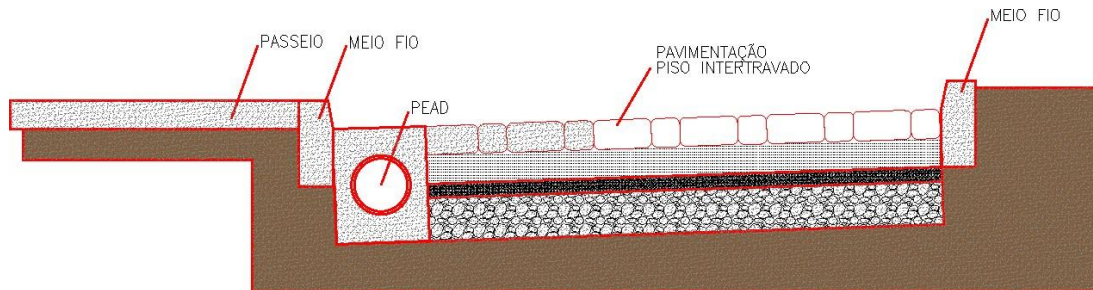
Perfil transversal com caixas de ralo de um lado da pista
